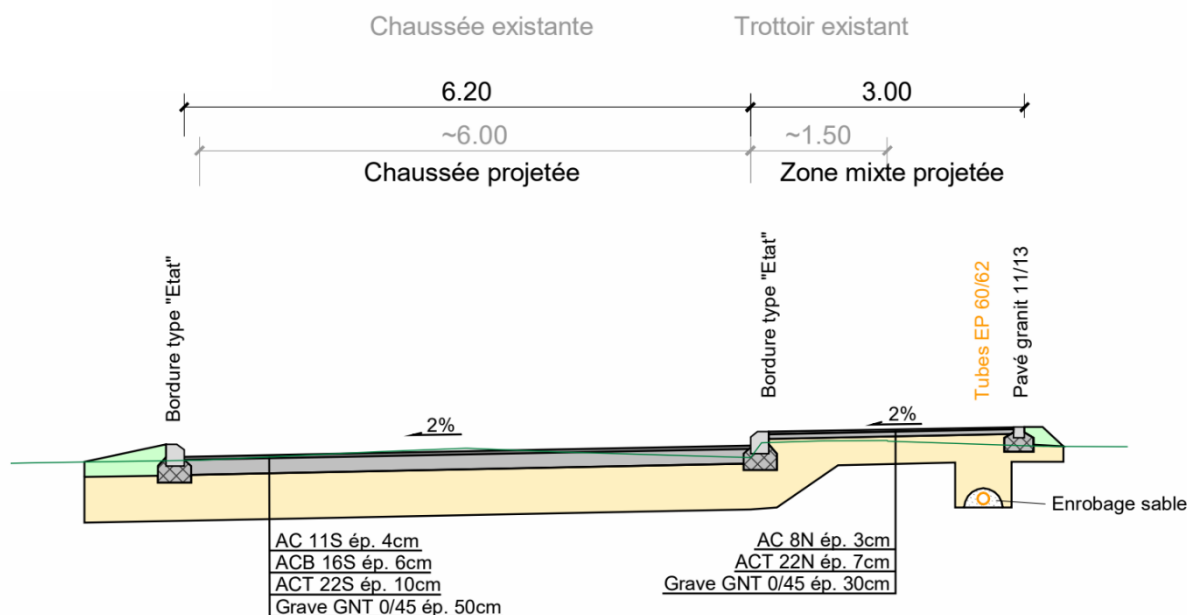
Coupe type D-D, Route de la Gare – Nord
